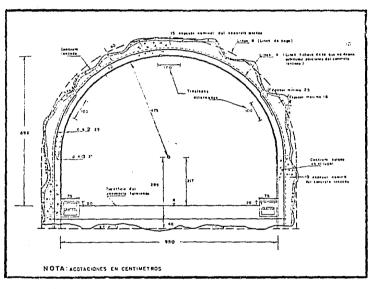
TUNEL DE SECCION IRREGULAR CON CONCRETO LANZADO.
